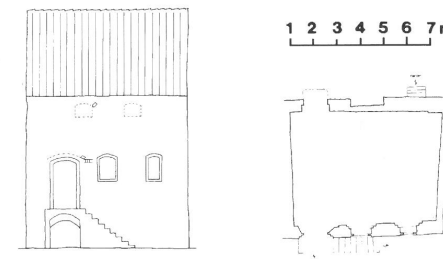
Adelgade 15 i Kalundborg, rekonstruktion af facade og plan. Åbningerne i overetagen er kun usikkert dokumenteret. På gårdsiden af huset sås spor efter en tilbygning af bindingsværk. Tegning: J. Ganshorn.
